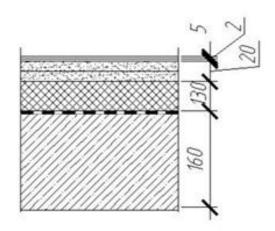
Конструкция перекрытия над неотапливаемым техподпольем
